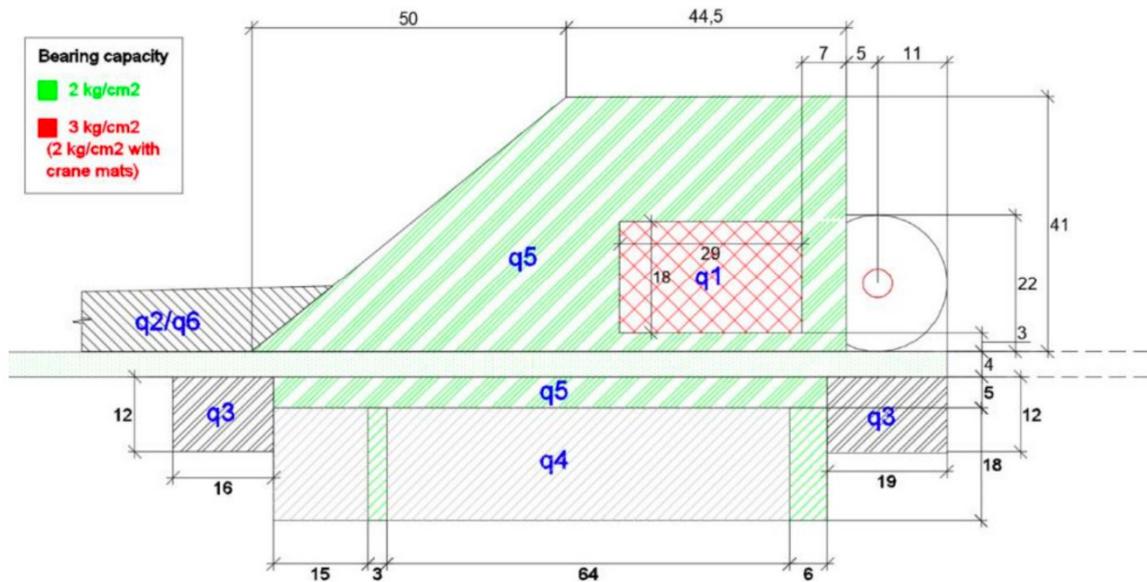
Configurazione fondazione standard. Pianta e Prospetto. Estratti dell'elaborato 01.W.D44 - Fondazione WTG – Particolari Costruttivi
